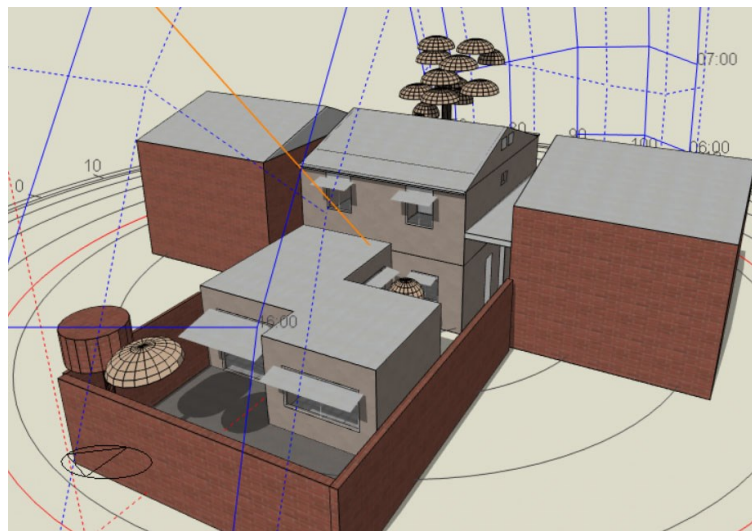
Perspectiva fachada posterior, incorporación de aleros
